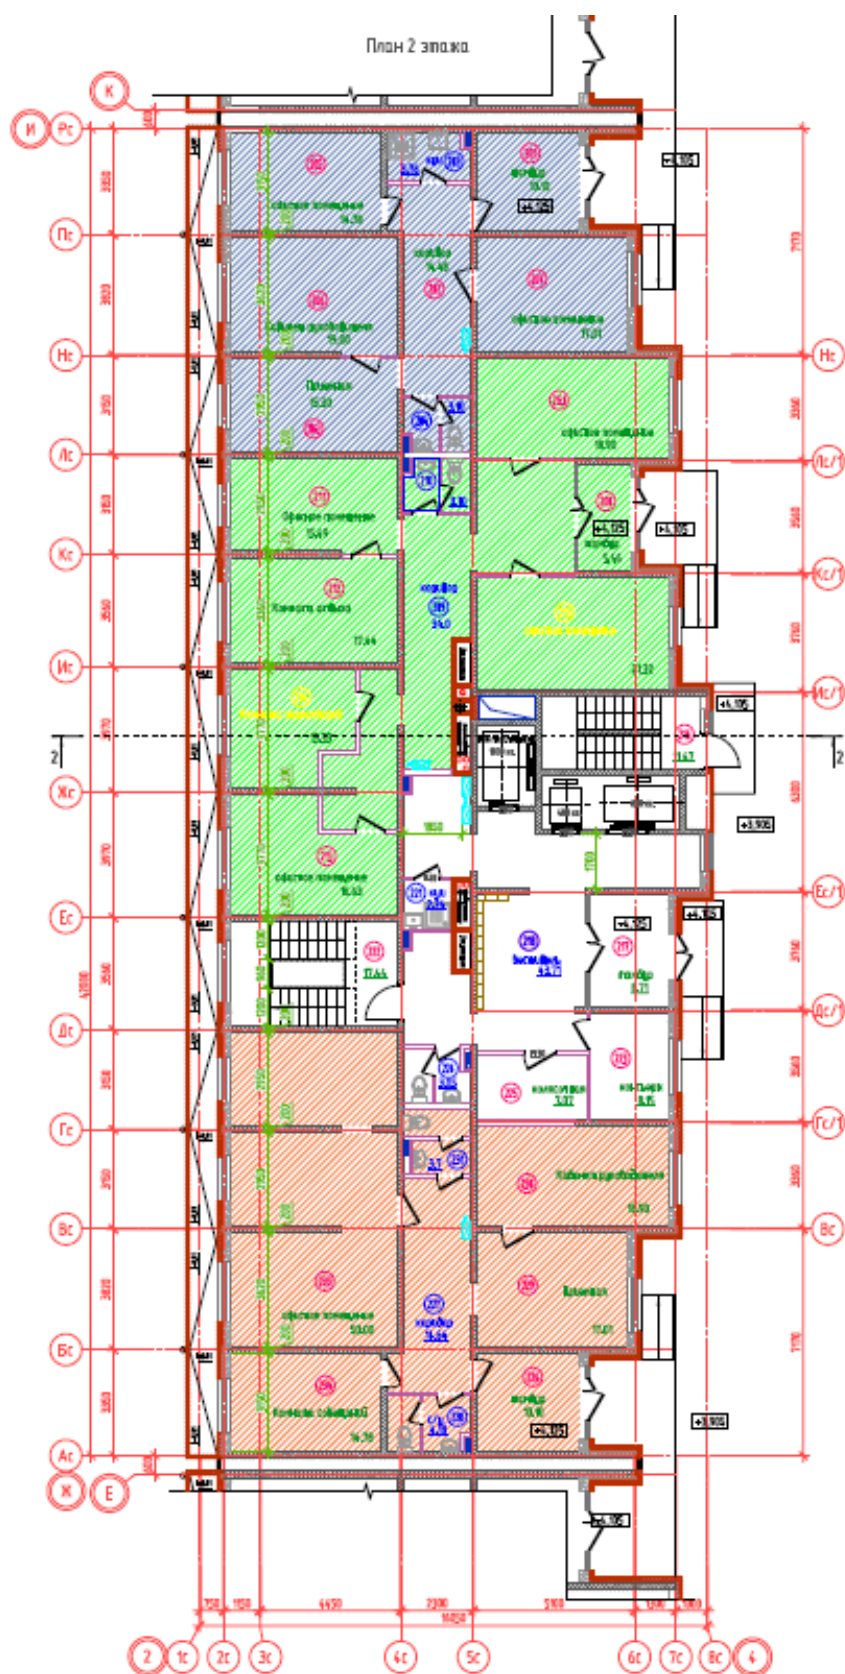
План 2 этажа БС-3 ЖК URAL
